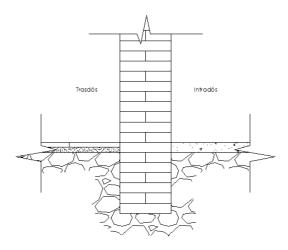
Encuentro de muro de carga de un pie con terreno. Fuente: Edición propia
